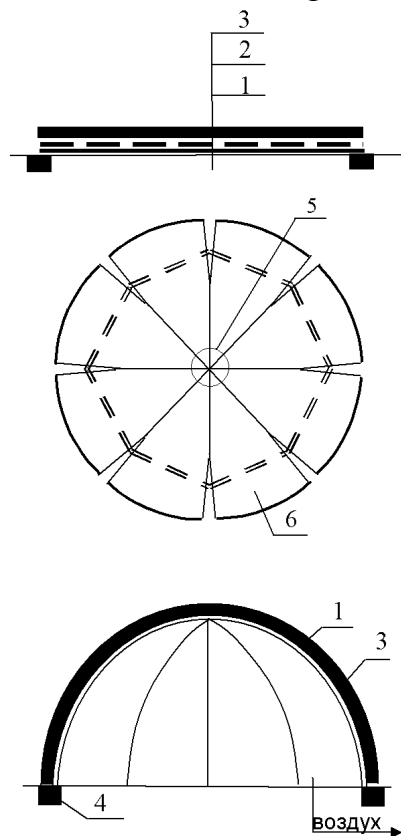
Схема возведения купольных конструкций на пневмодинамической опалубке: 1 - пневмоопалубка, 2 - арматурный каркас, 3 - бетонная смесь, 4 - основание, 5 - элемент вершины пневмоопалубки, 6 - открылки
